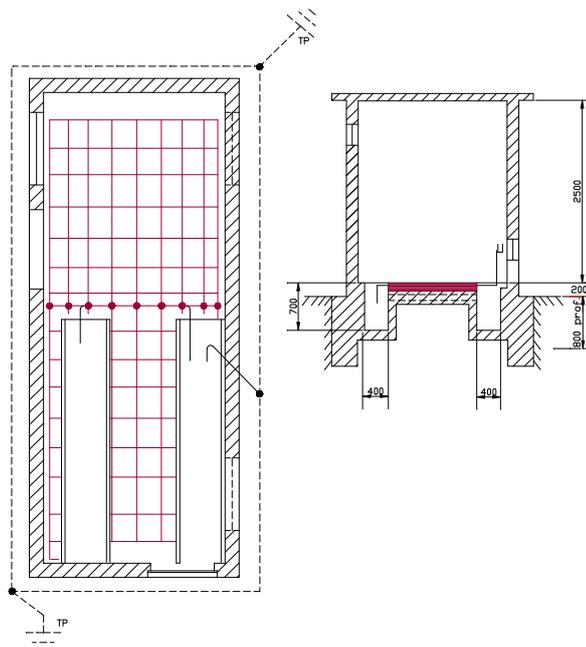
PT tipo CB • Ligação da malha equipotencial à terra
